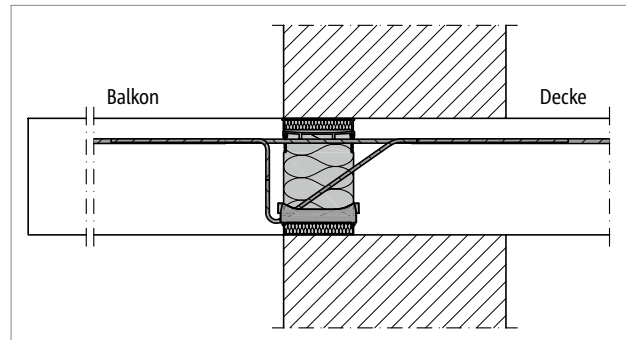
Schöck Isokorb® XT Typ KL: Anschluss bei einschaligem Mauerwerk
